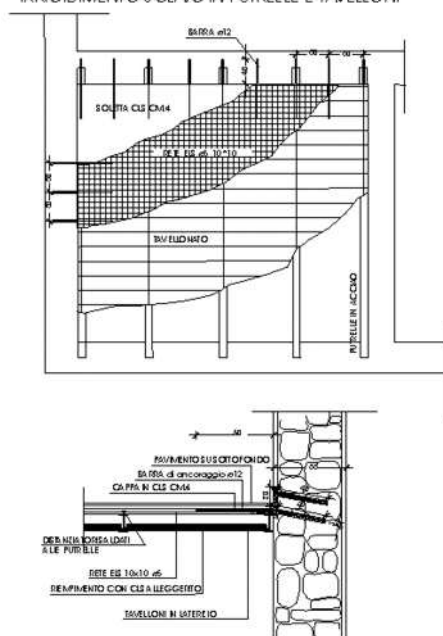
Realizzazione di irrigidimento di un solaio in putrelle e collegamento alle murature (1999).
